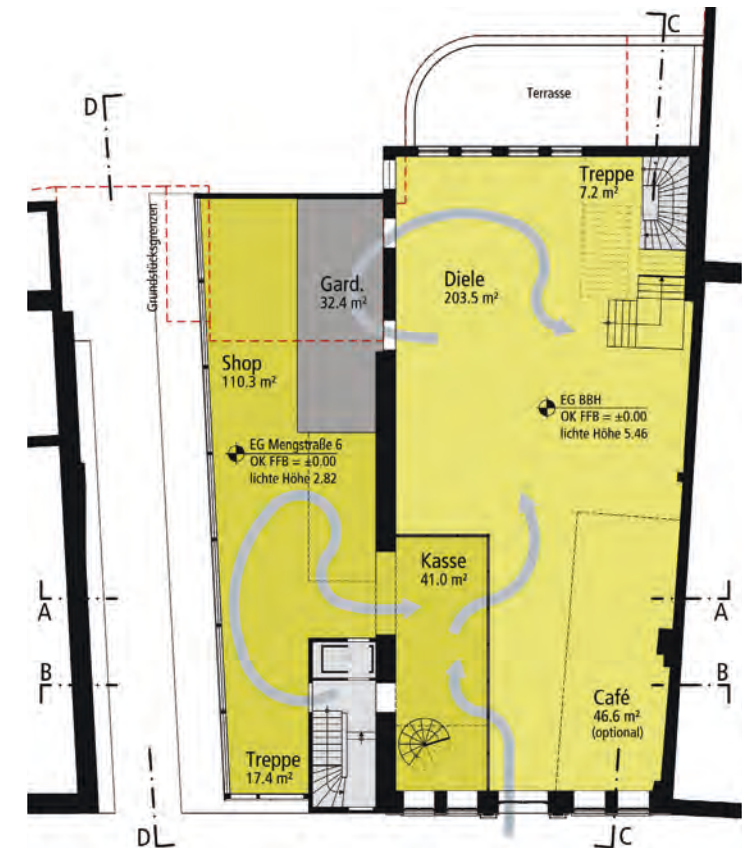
Variante 3, Grundriss Erdgeschoss
